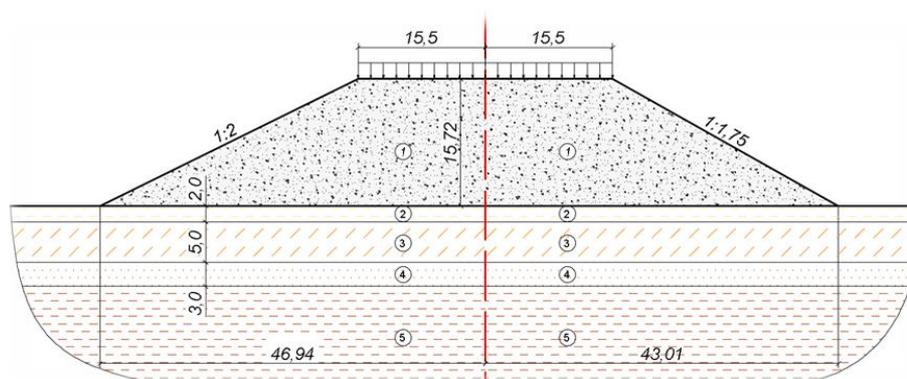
Схема оцениваемой насыпи (номера грунтов по слоям соответствуют табл.1)
